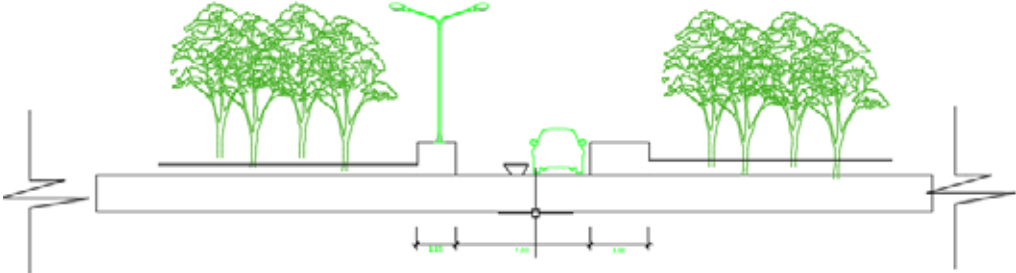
Arterial propuesta, acceso Facultad de Arquitectura y Biblioteca central (2018)
